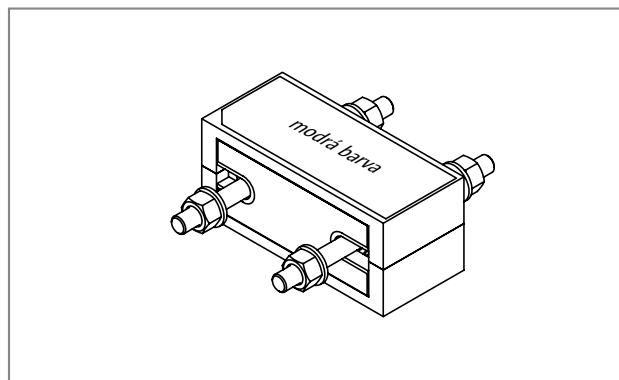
Schöck Isokorb® T typ S-V-D22: Řez prvkem
